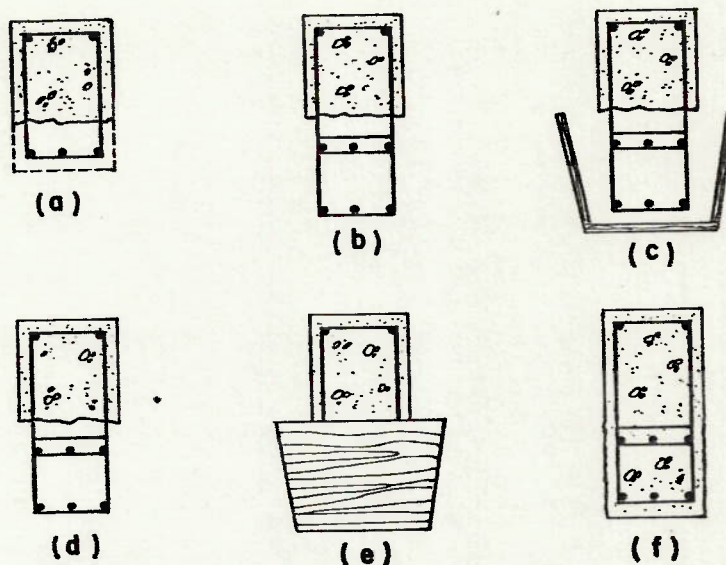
Reforço de viga com concreto e armaduras suplementares
